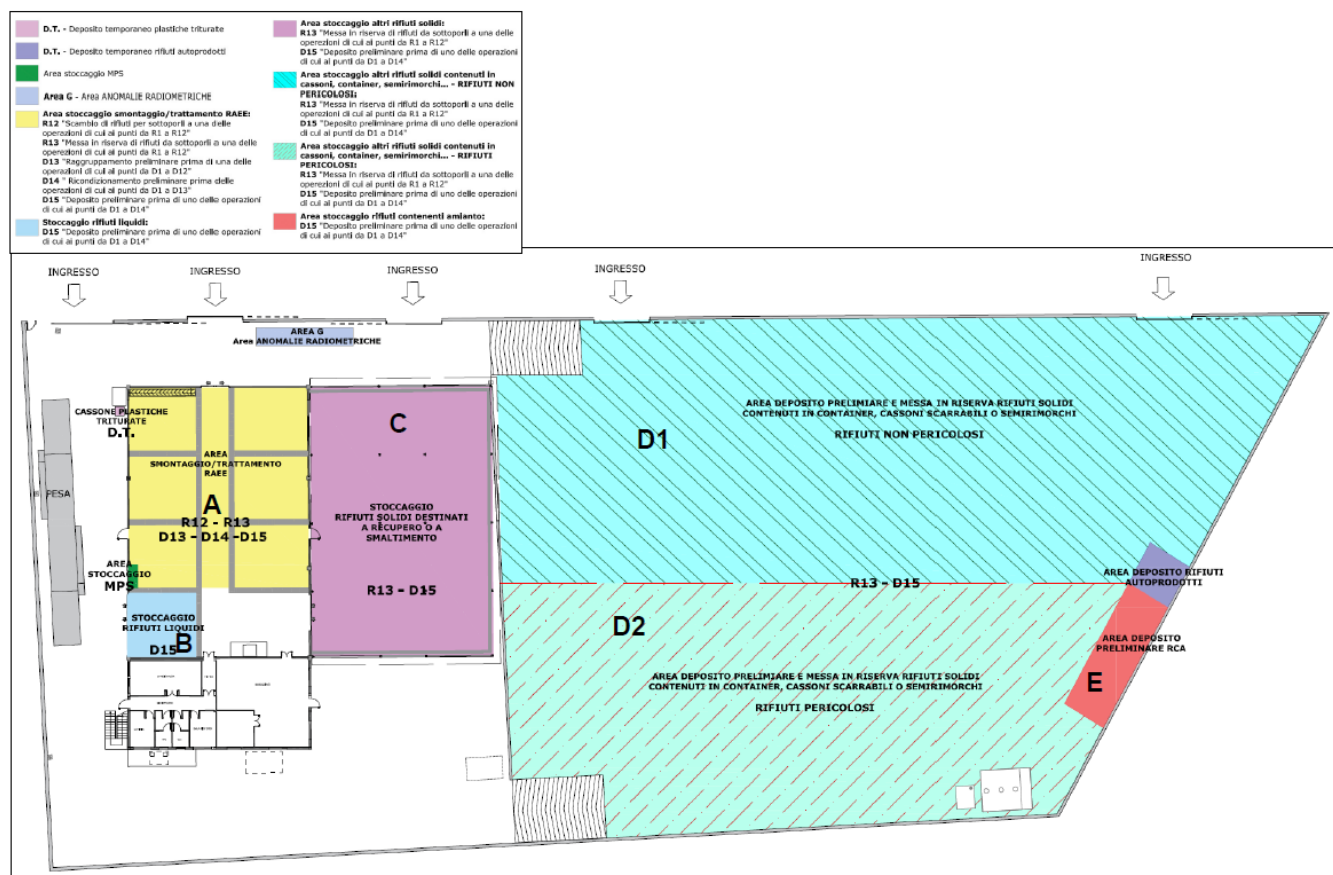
Stralcio Planimetria con classificazione delle nuove aree funzionali (post operam)
